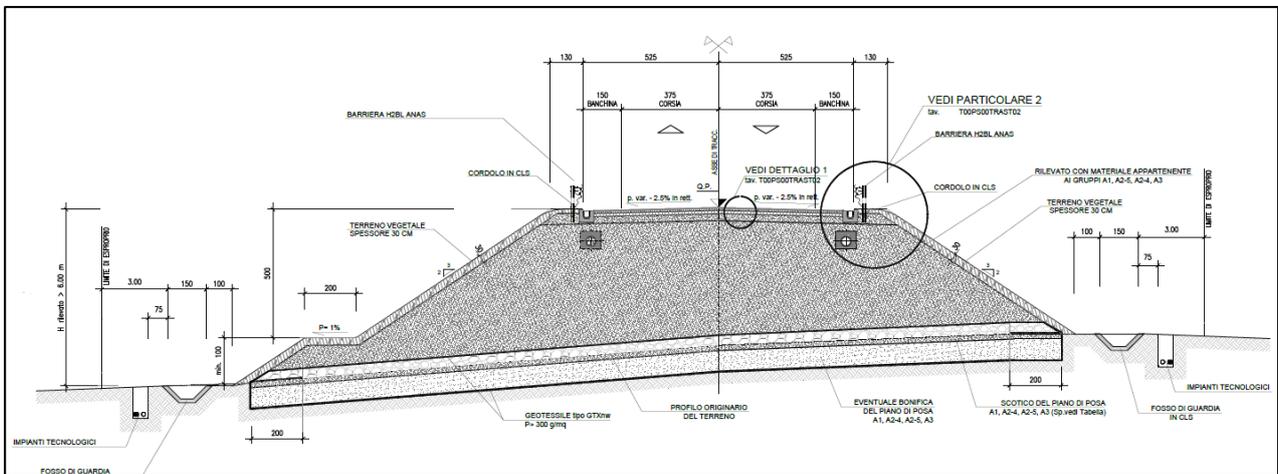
Sezione tipo C1 in rilevato con $H > 5$ e $H < 6$
